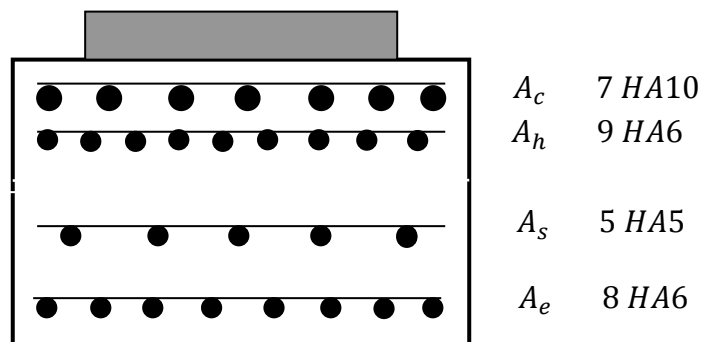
Ferrailage du dé d'appui – coupe transversale.
